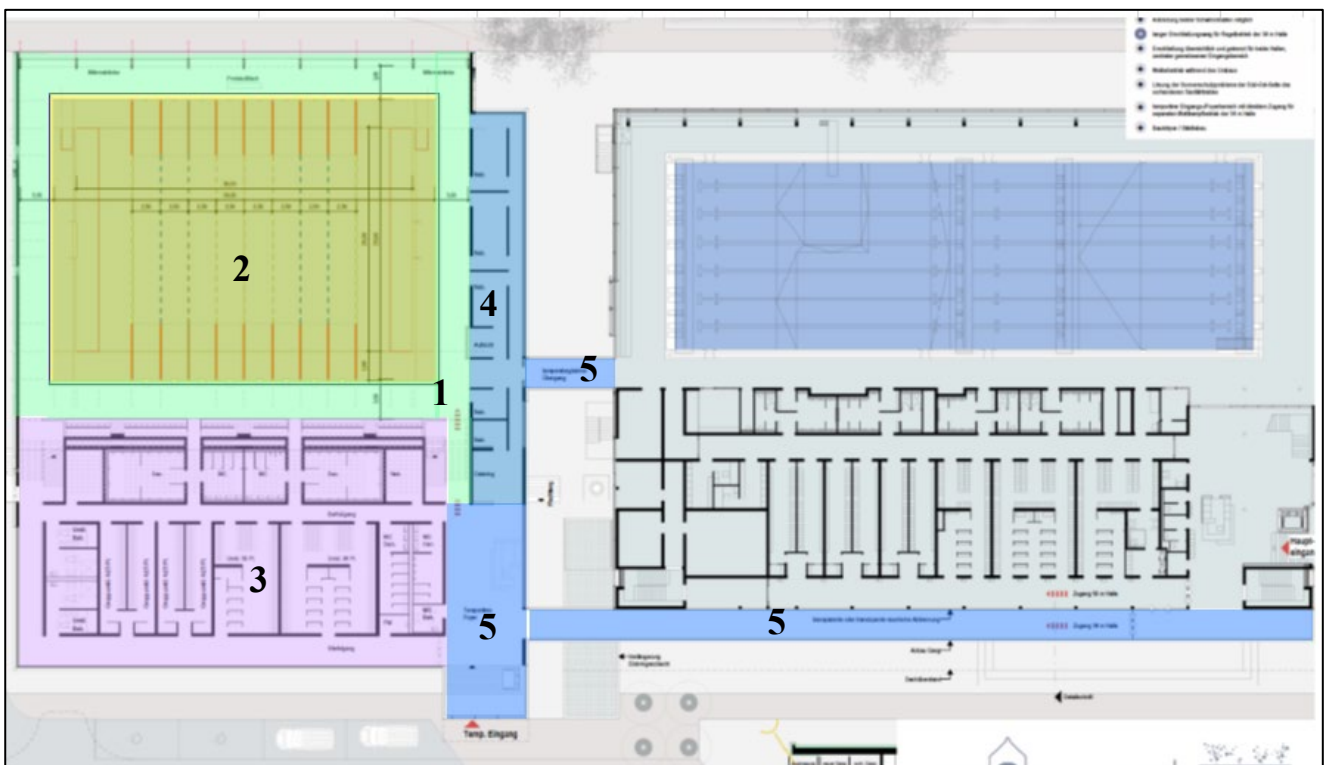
Auszug aus [1] - Grundriß Erdgeschoss Variante 3 (Blatt 17) mit Zonierung
